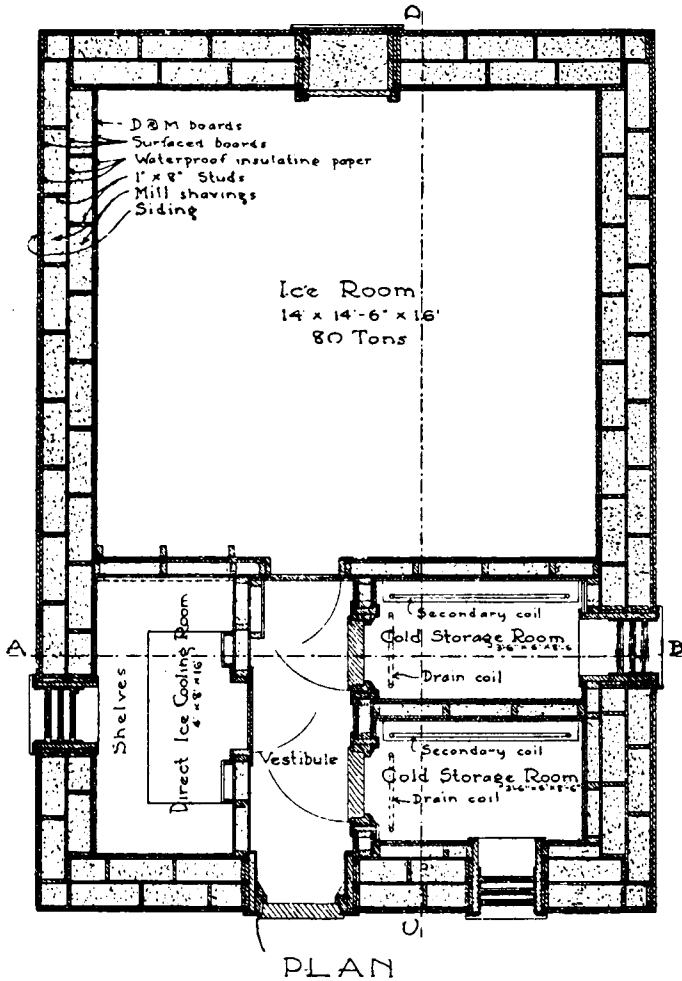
Планъ. D. & M. boards—Обшивочныя доски (обшелевка).—Surfaced boards—Чистыя доски.—Waterproof Insulating Paper—Водонепроницаемый изолировочный картонъ.—1"×8" Studs—Стойки 1"×8".—Mill. Shavings—Опилки.—Siding—Облицовка.—Ice Room—Лѣдохранилище.—Shelves—Полки.—Direct ice cooling room—Камера съ непосредственнымъ охлажденіемъ отъ льда.—Vestibule—Сѣни.—Secondary Coil—Вторичный змѣвикъ.—Cold Storage Room—Холодная камера.—Drain Coil—Сточная труба.
